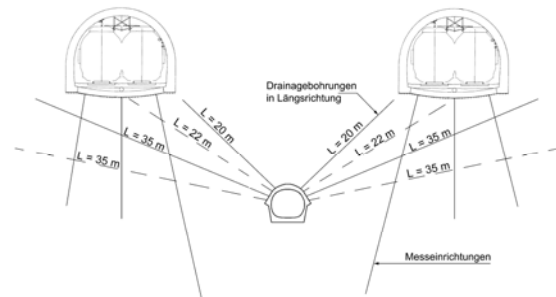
Drainagestollen zwischen zwei Tunnelröhren [36]
